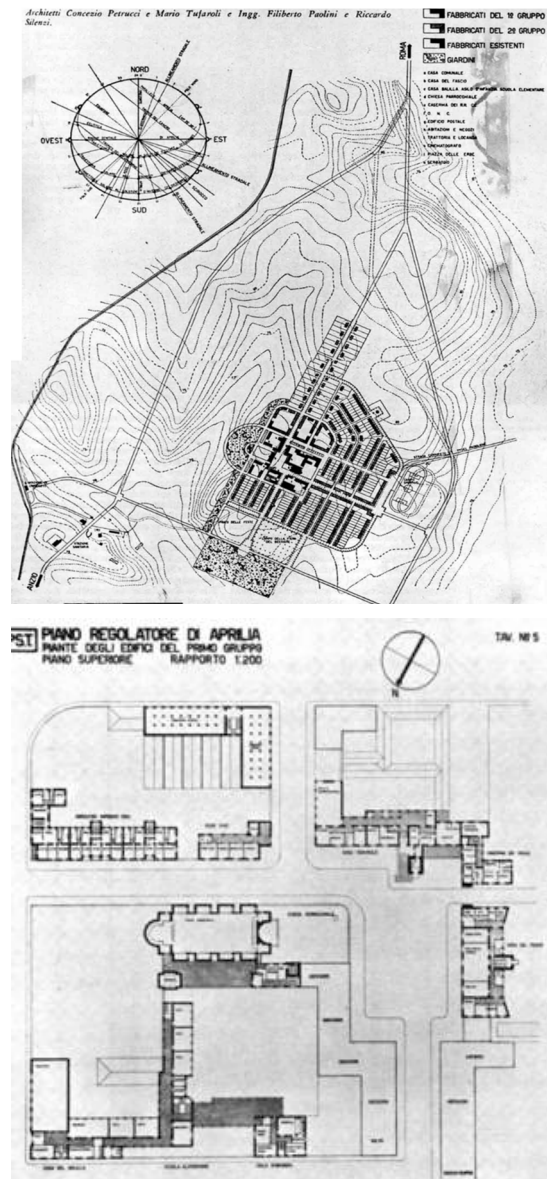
Planimetria generale del Prg di Aprilia; a destra un dettaglio della sistemazione planimetrica della piazza centrale; si notino i piccoli slarghi creati in corrispondenza della facciata della chiesa e al lato della torre municipale.
